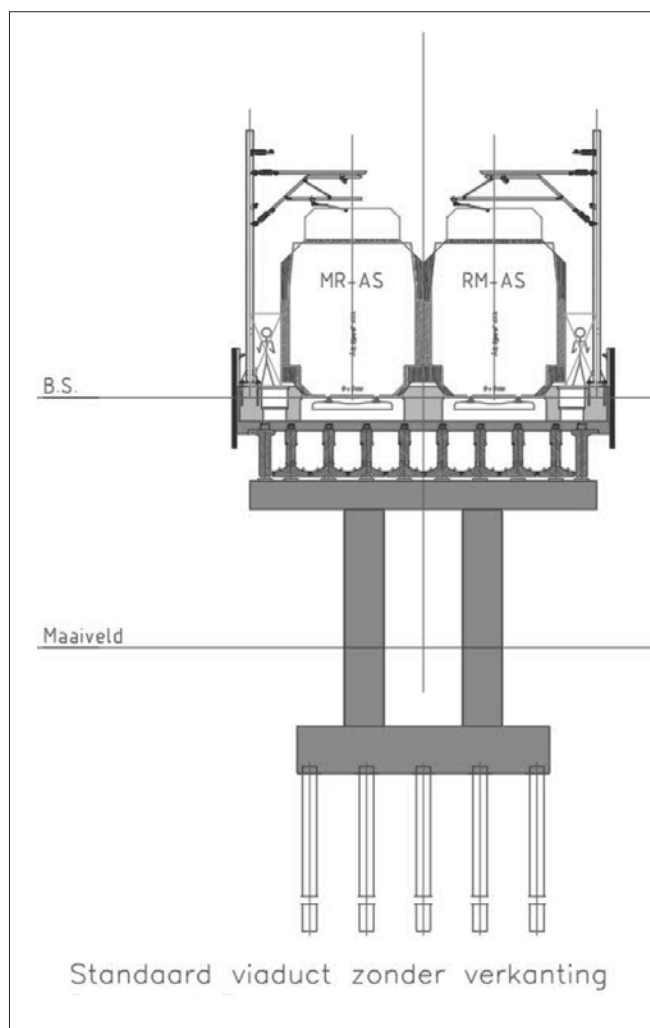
Weergave constructie type 1a prefab betonliggers in combinatie met pijlerbalk (MER-ontwerp)
